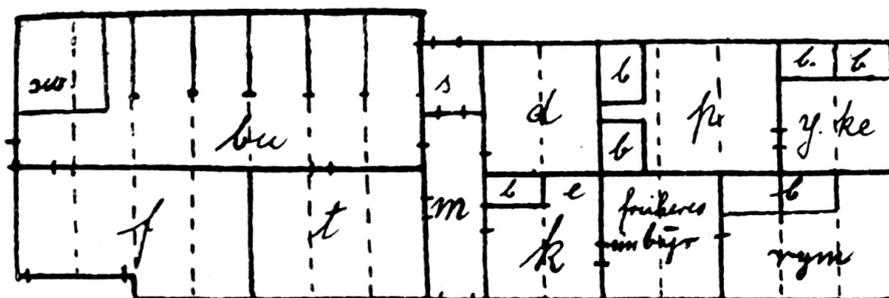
Grundriss v. Haus Sönke Oldsen, Oevenum (Peters 1913: 23)
